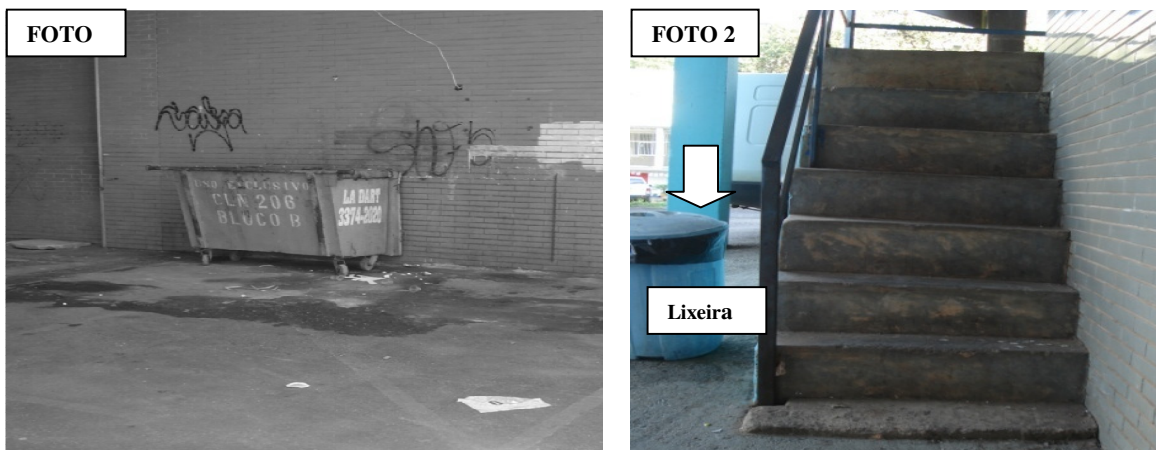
Vagas Foto 1, Lixeira (L1); Foto 2, Lixeira (L2)
